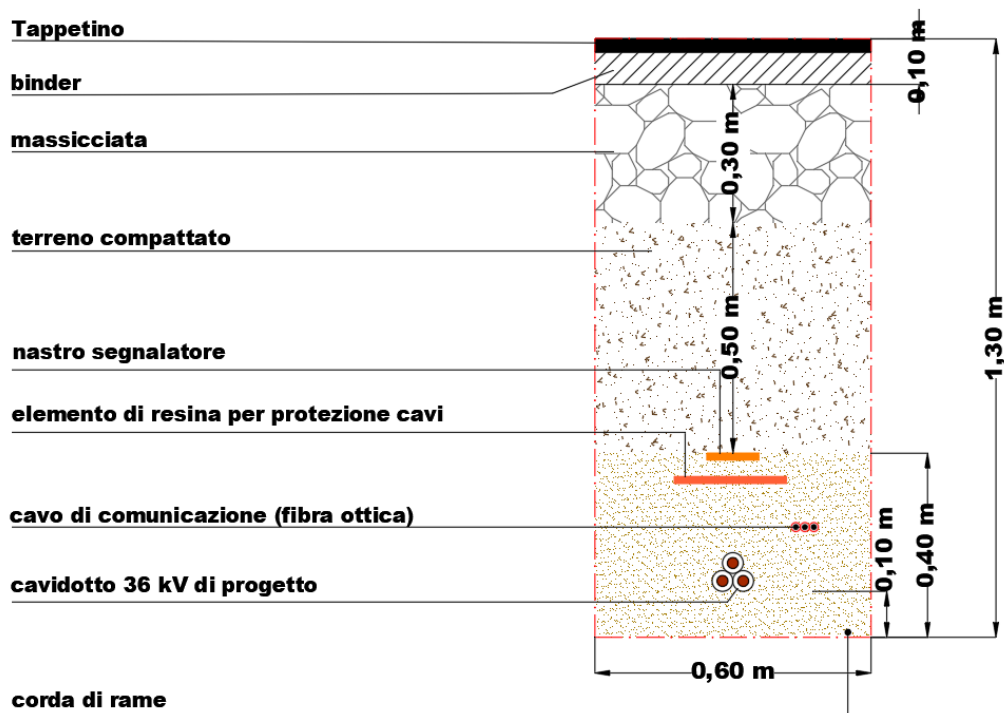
Sezione del cavidotto singola Terna su strada asfaltata
